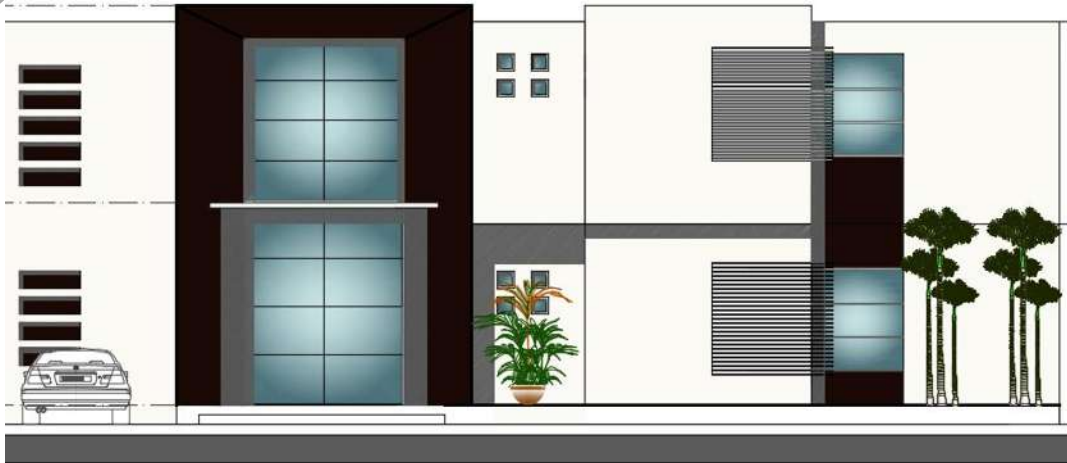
Fachada del primer modelo de vivienda con 290m² de construcción
